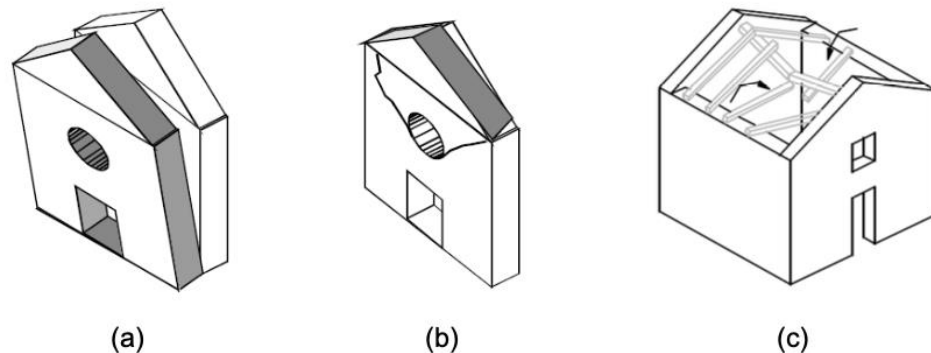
Fallas locales fuera del plano en edificaciones de mampostería: (a) colapso total de la fachada, (b) colapso parcial y (c) colapso de cubierta. Fuente: D'Ayala, 2000.
